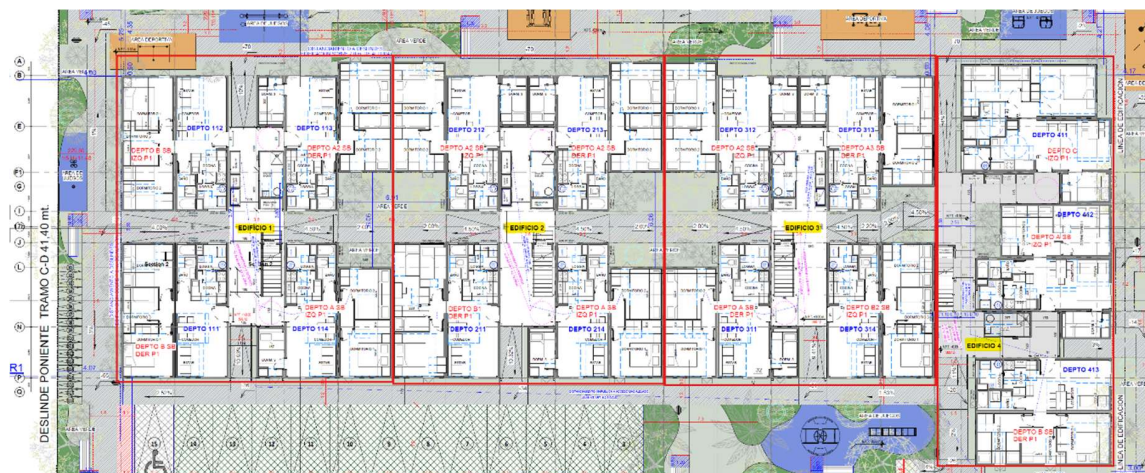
Detalle de suministros y servicios instalados en obra. Fuente: Archiplan
